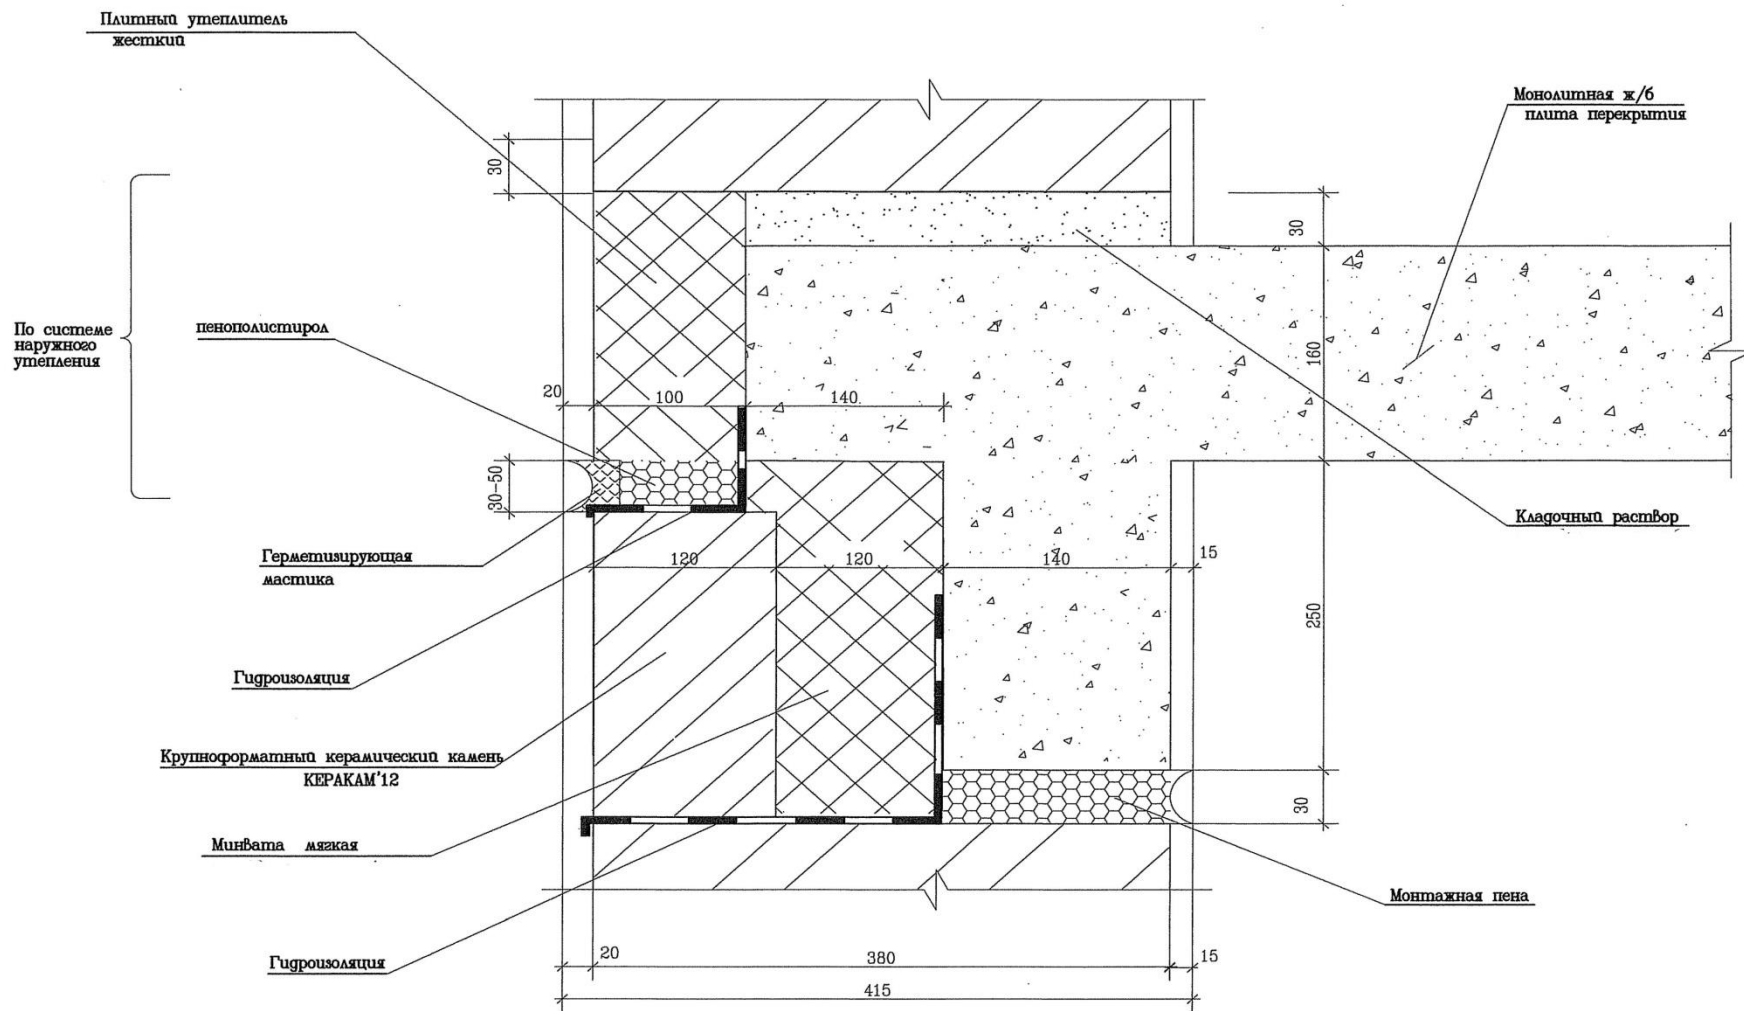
Узел 1 (стены с плитой перекрытия с балкой).
